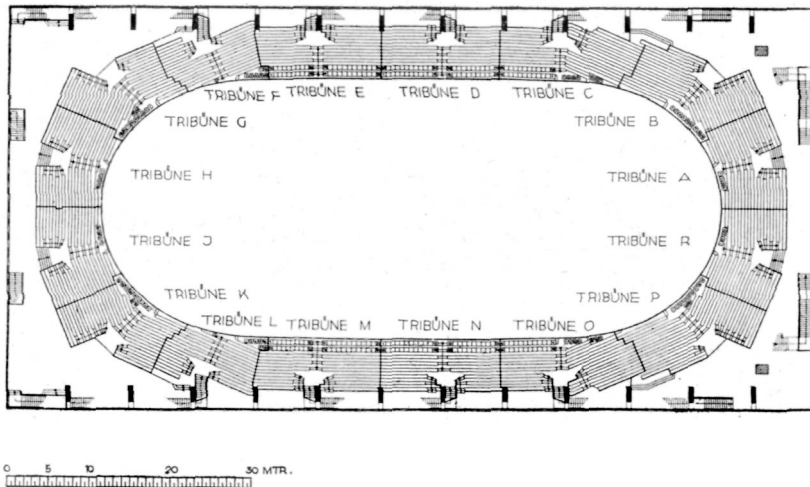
Sporthalle Stuttgart. Grundriß der Tribünen
